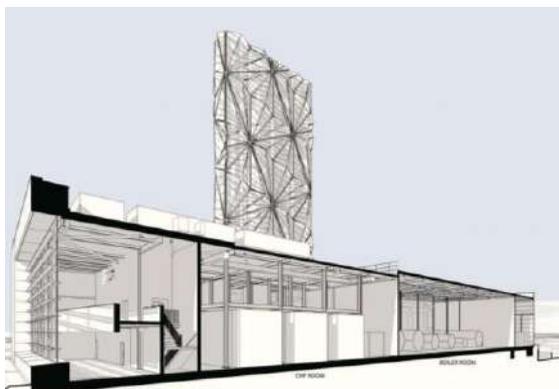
Сечение рабочих корпусов ТЭЦ.
